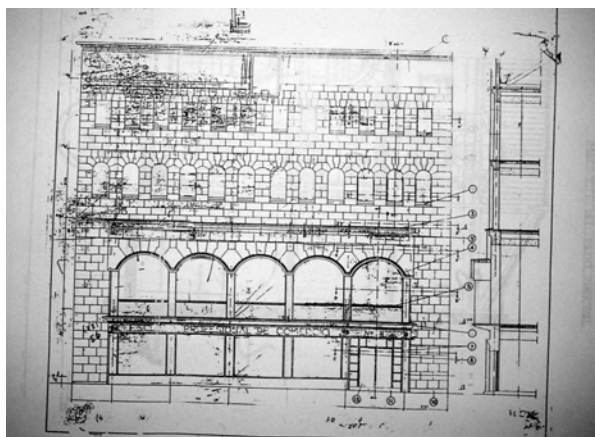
Palacio de San Boal: planimetría proyectada por D'Ors.
